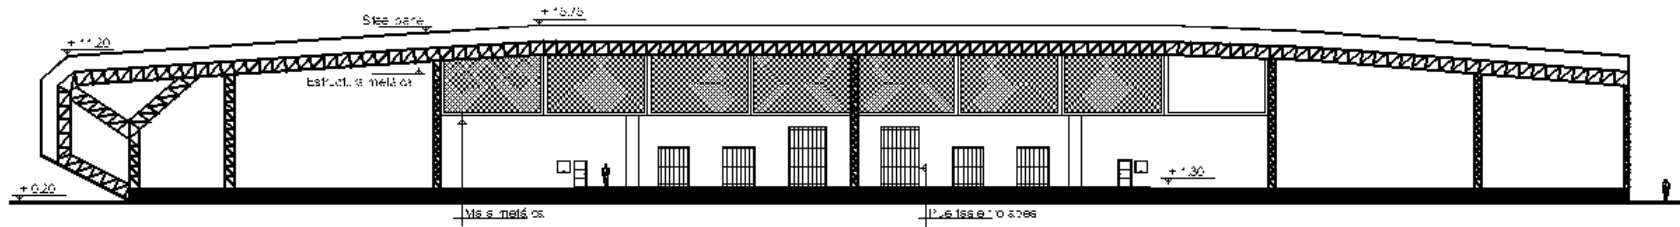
Planta arquitectónica de Galpón Espacio contenedor 2
